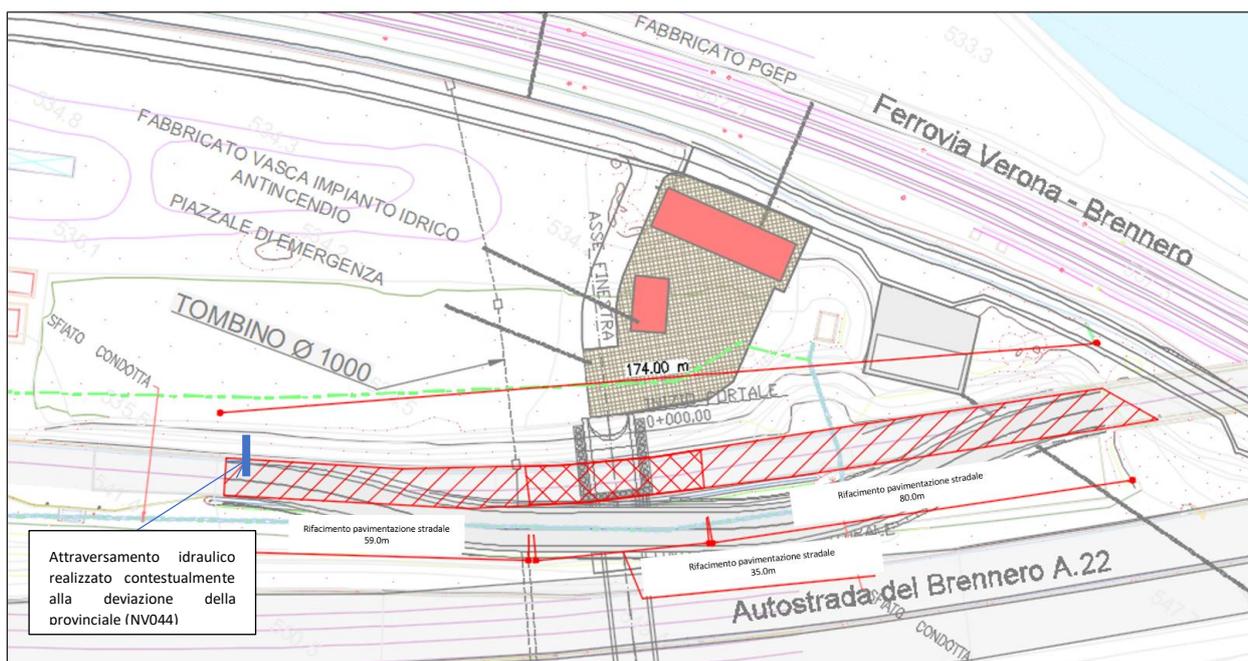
Schema planimetrico del ripristino della viabilità esistente
